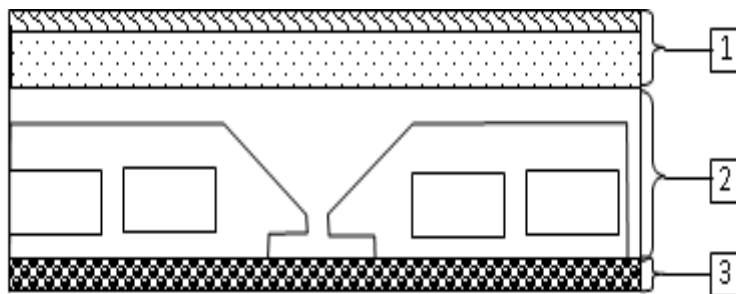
Section transversale d'un plancher à corps creux d'étage courant
